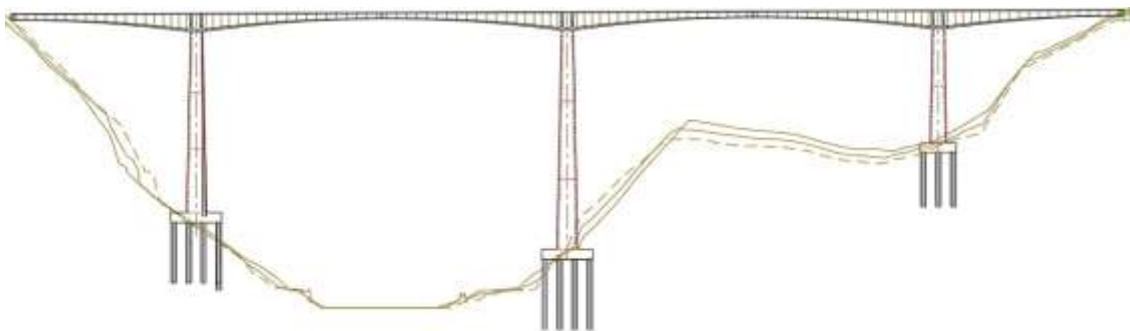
Vista longitudinal Puente El Tablazo. Adaptado de planos.
